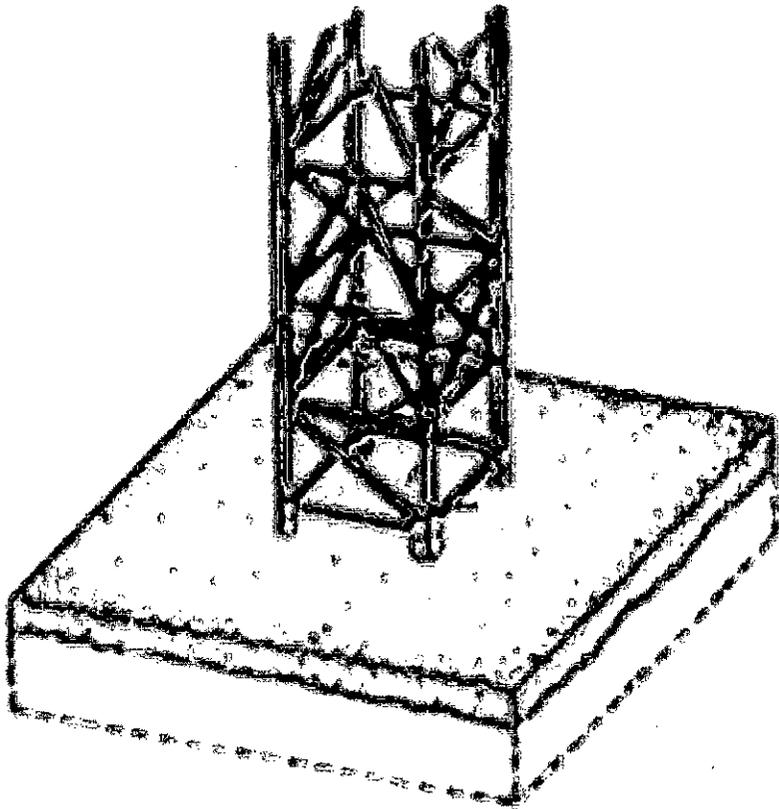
GRÚA TORRE EMPOTRADA EN BASE DE CONCRETO.
